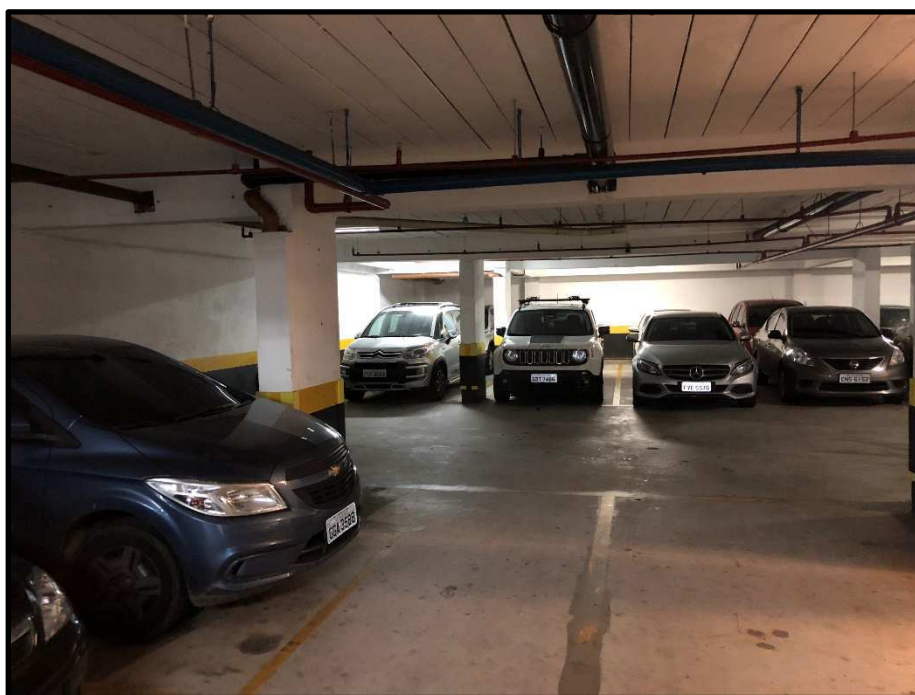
1º subsolo – vagas de garagem – Vista 2
